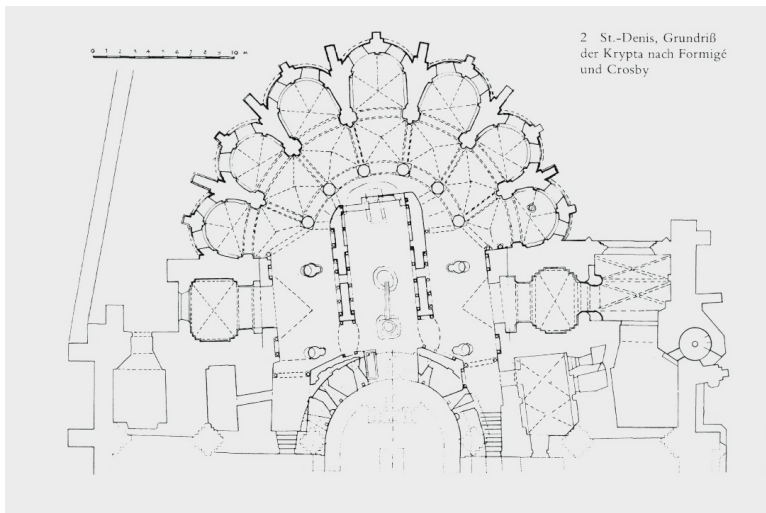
Grundriss der Krypta von Saint-Denis
